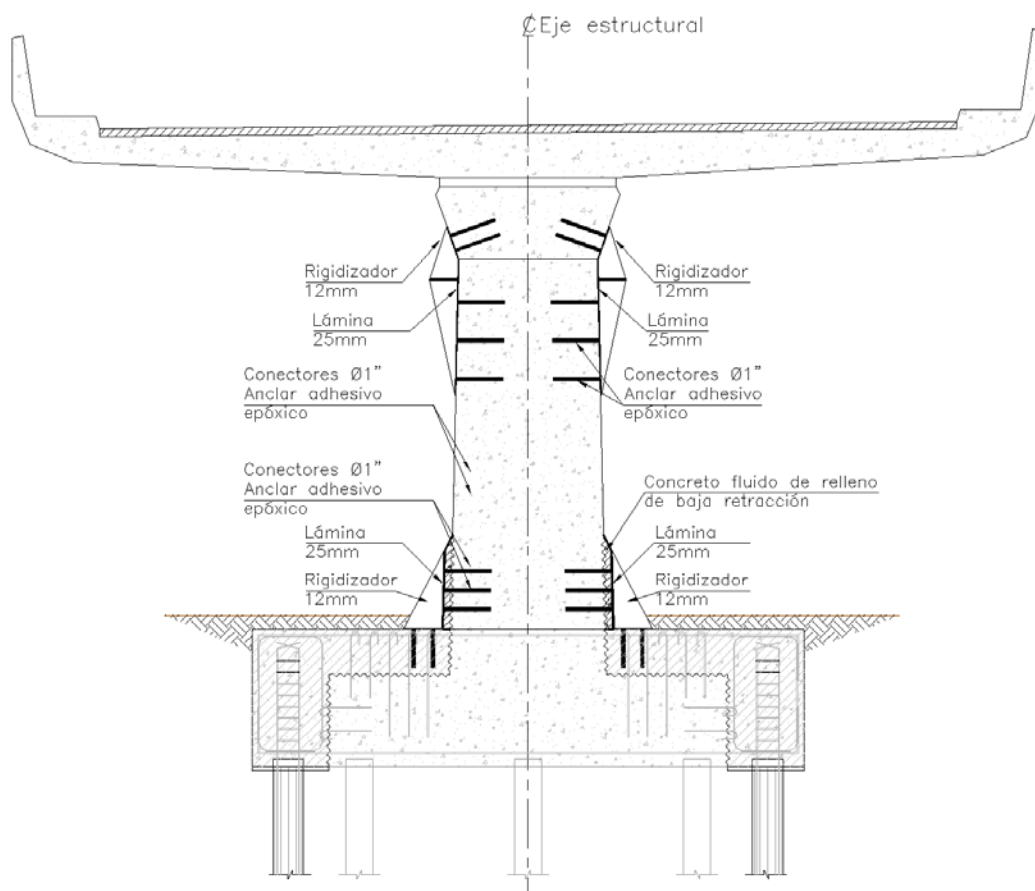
Propuesta de Intervención para repotenciación sísmica columnas Ejes 2 y 6
